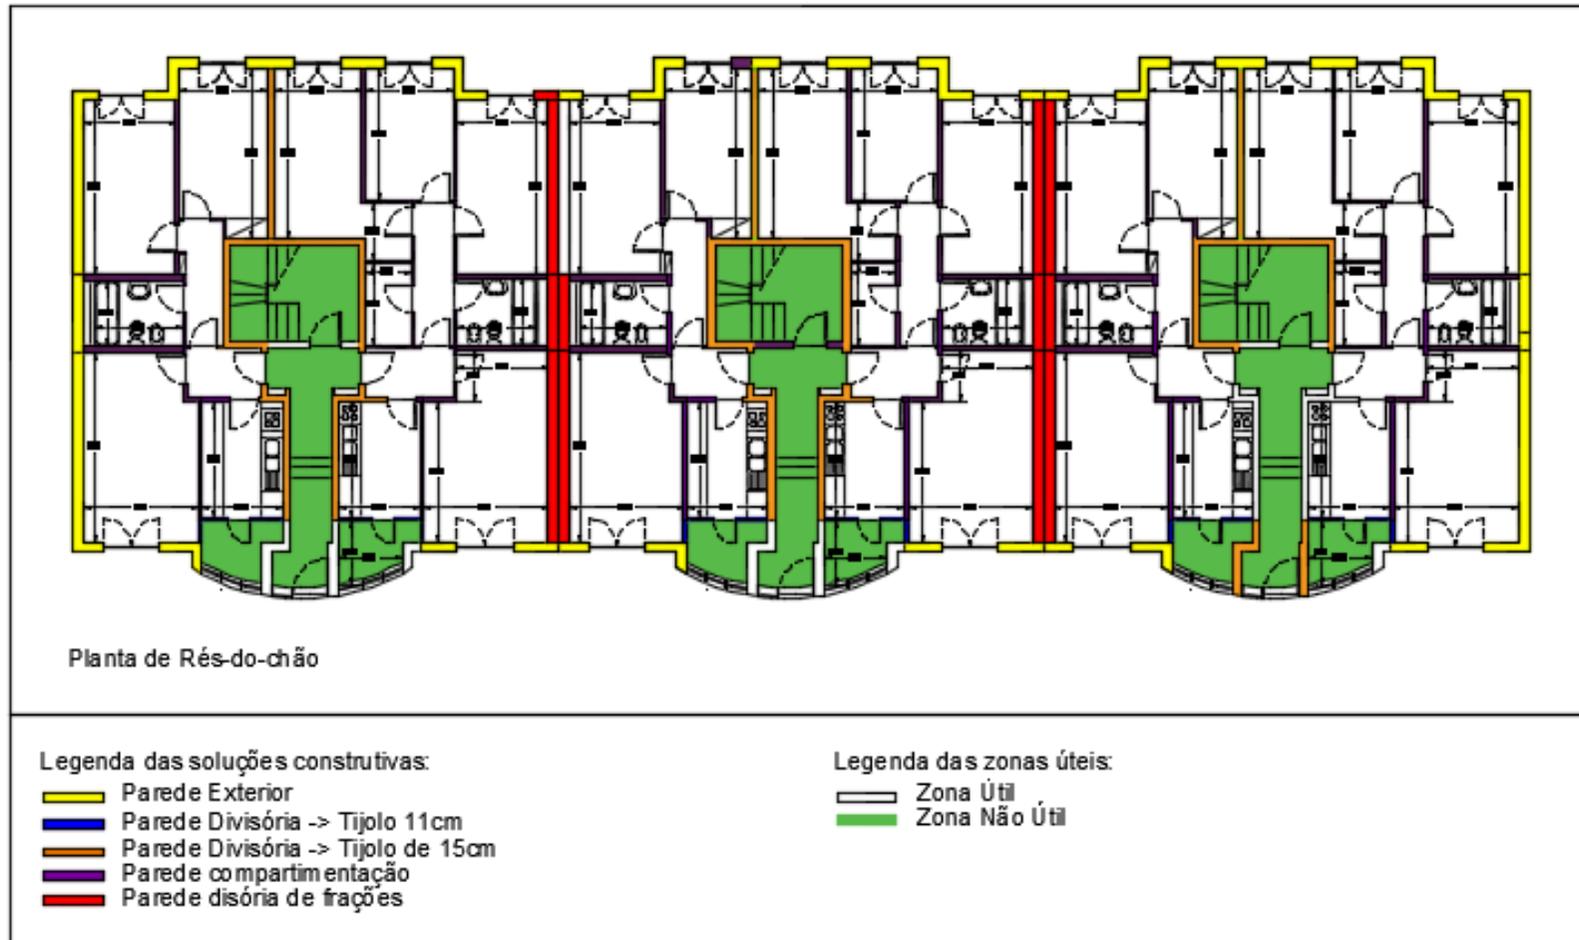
Soluções construtivas – Planta do Rés-do-chão
